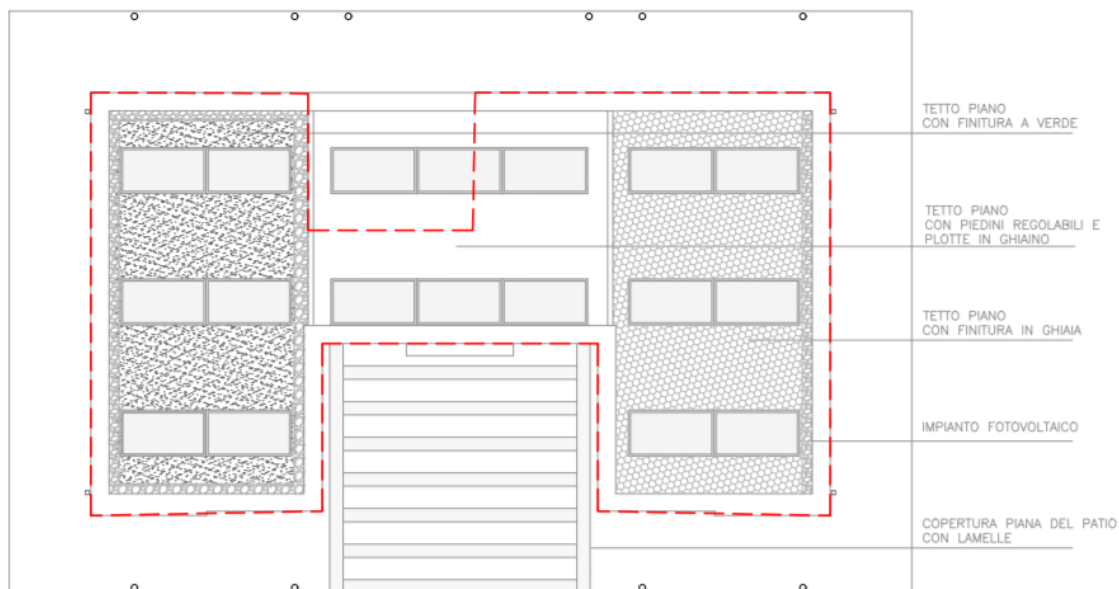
Disposizione dei pannelli fotovoltaici sul tetto dell'edificio.
